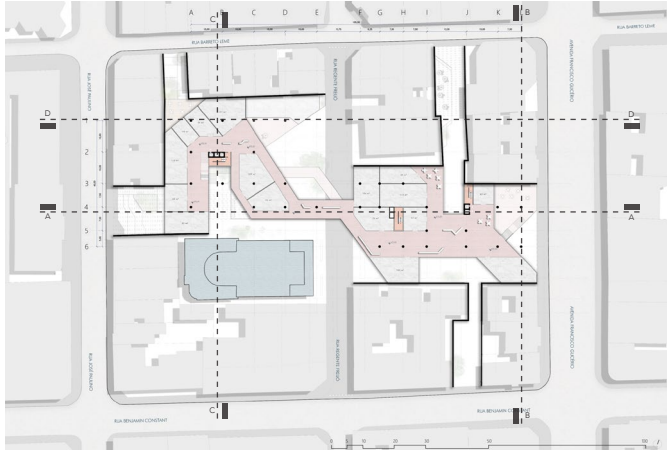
Planta do segundo pavimento (galeria) / Fonte: Autoria do grupo
